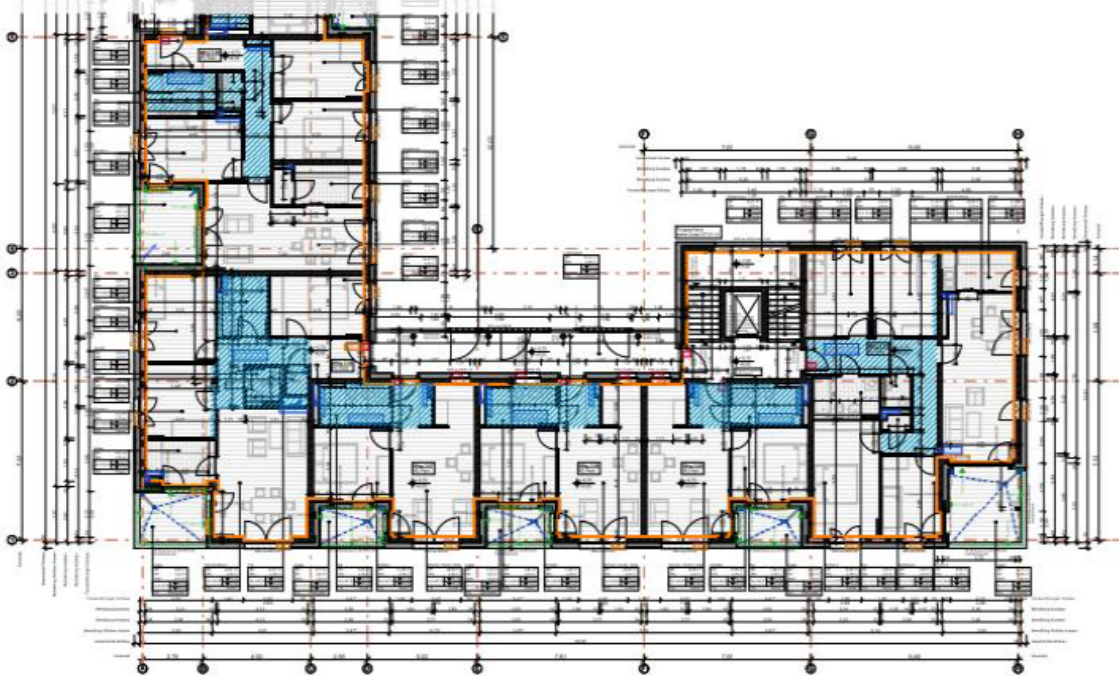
, 14: Loggien (unten) und Grundriss (oben) mit luftdichter Hülle (orange) und abgehängten Decken (blau)
